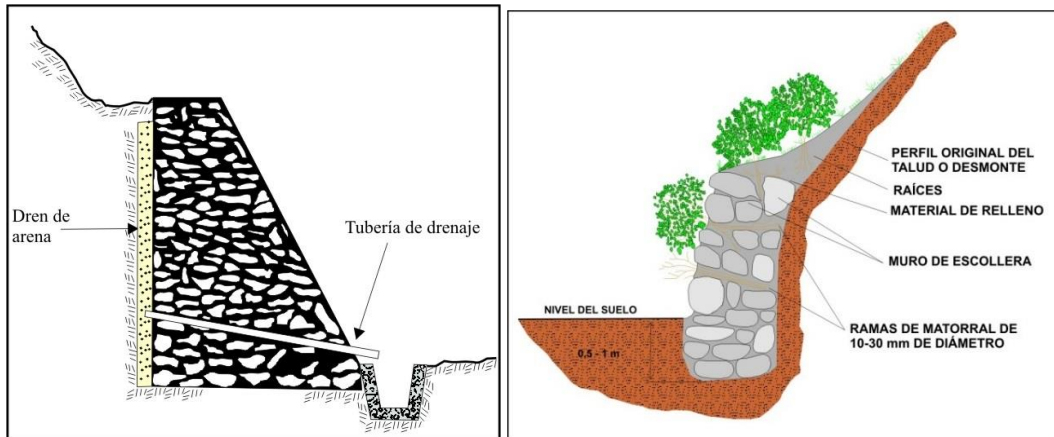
A). Muros de gravedad de piedra seca. Figura 18 B) Muros de gravedad de piedra argamasada.
